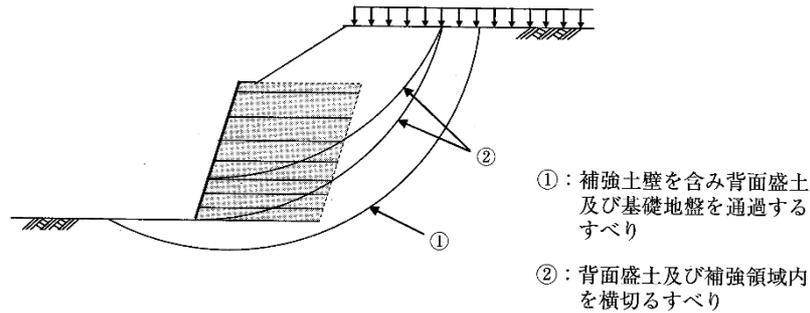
想定される全てのすべり面に対する安定の照査⁸⁾
